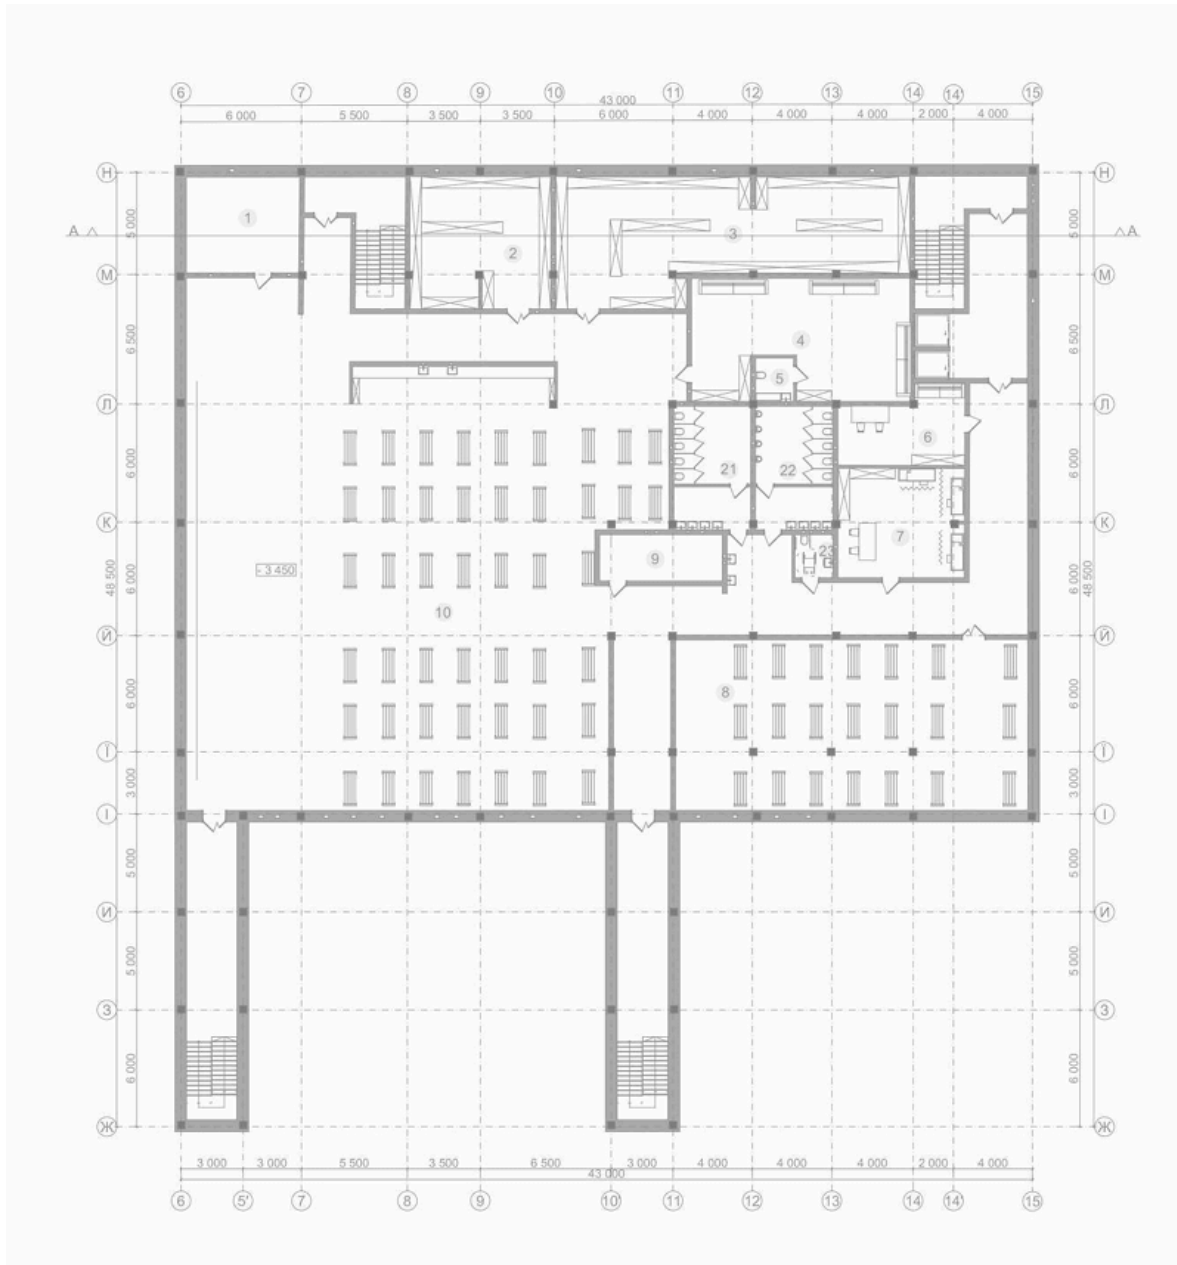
План підвального поверху на відмітці - 2.400 М 1:250.
